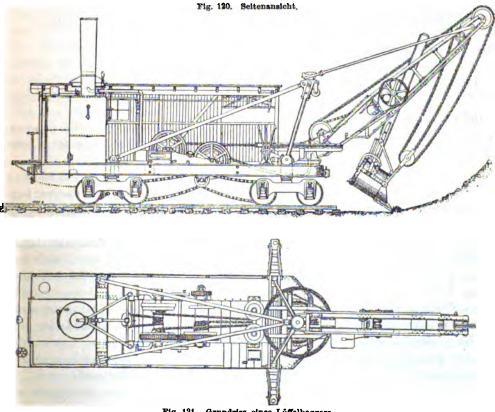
Grundriss eines Löffelbaggers.
